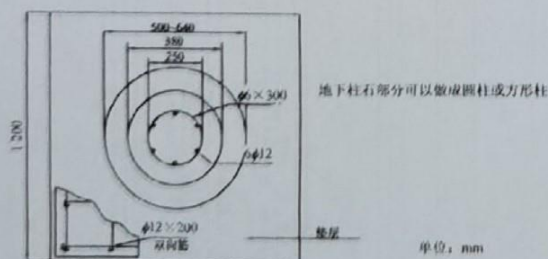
基岩 GNSS 观测墩剖面图 (单位 mm)
